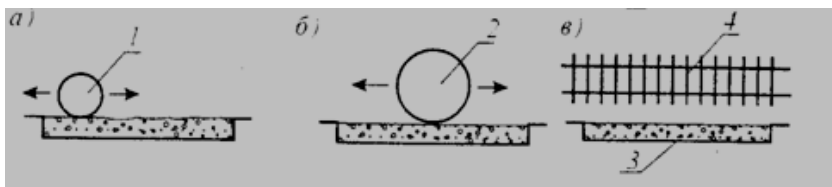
Уплотнение бетонной смеси при формировании плит
